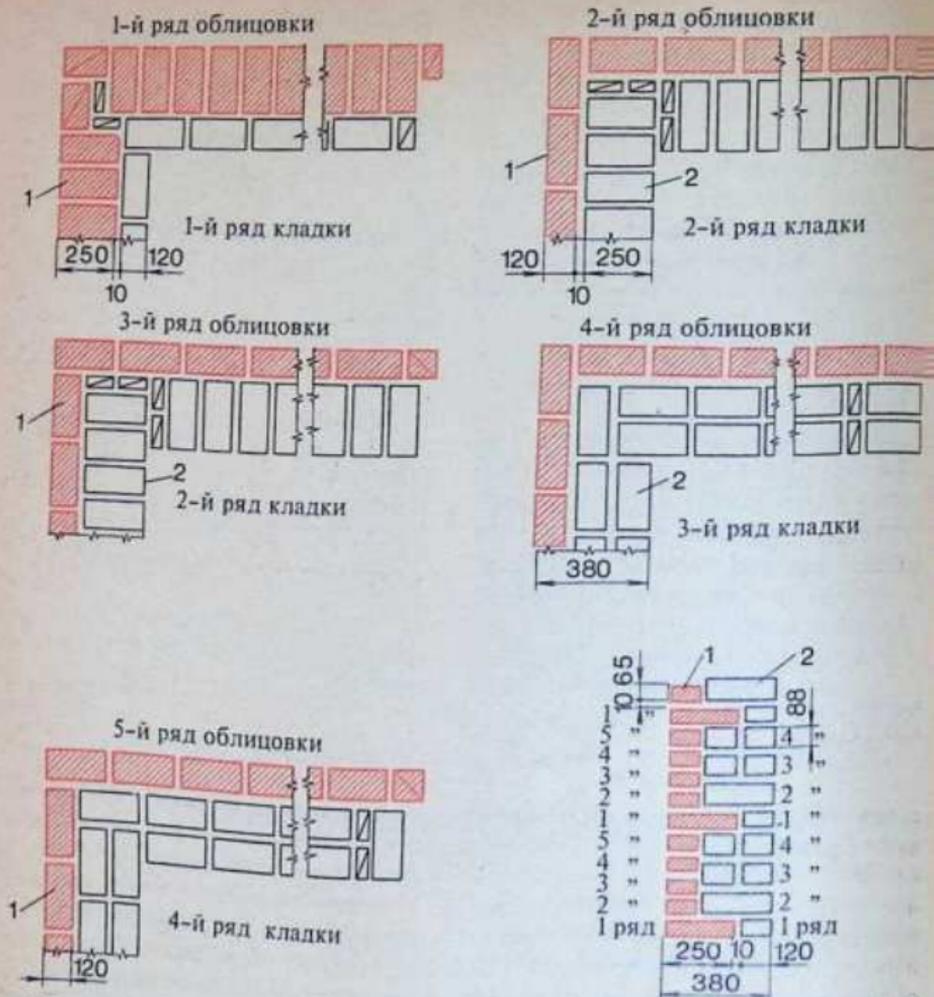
Перевязка кладки из кирпича толщиной 88 мм с облицовкой лицезым кирпичом (толщина стены 380 мм):
